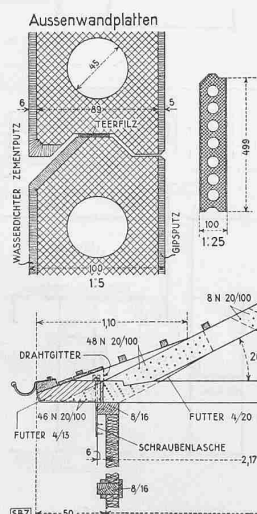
Fensterdetail 1:10; Plattendetail 1:5 und 1:25
